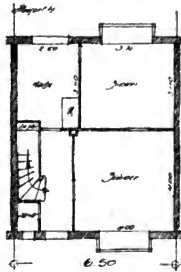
126. Grundrisse zu Abb. 122.
